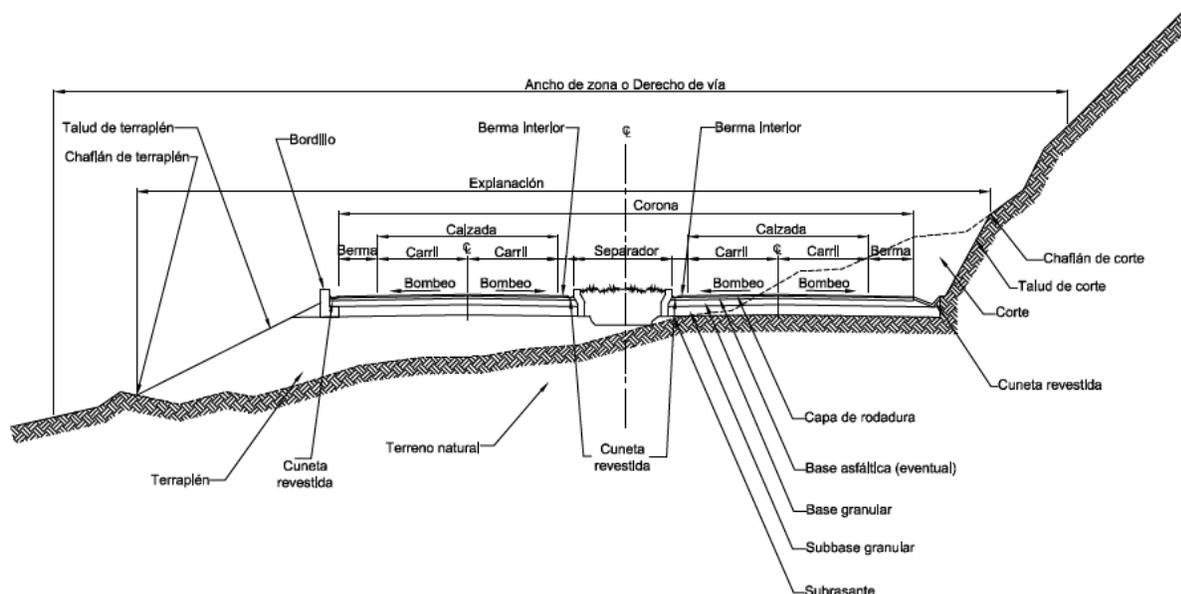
Sección transversal típica de una carretera con calzadas separadas
